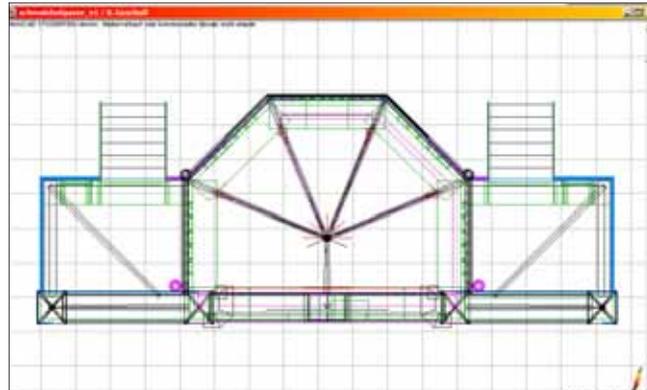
Grundriß der Ebene: "Objekt_12" (Endfassade)
